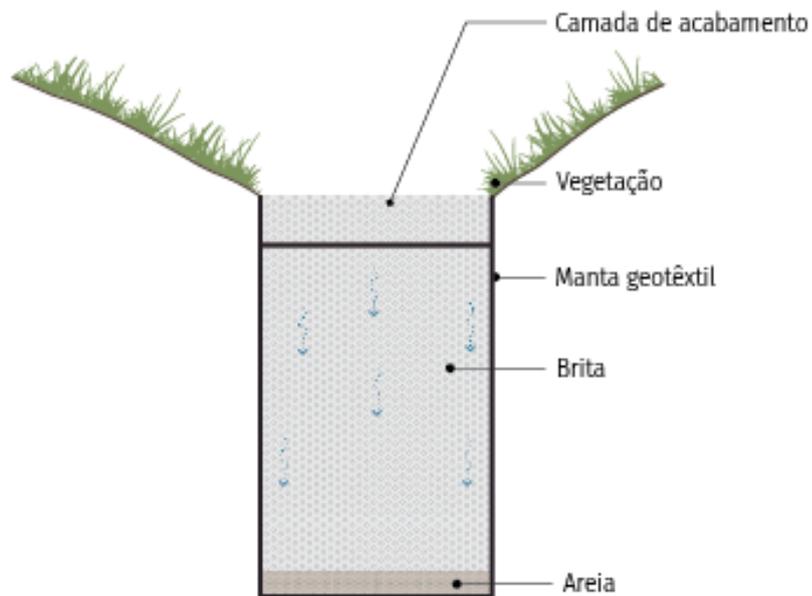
Corte esquemático de facilitador de infiltração do tipo bacia
